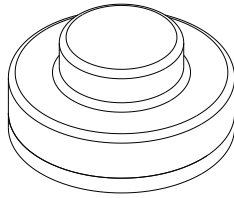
Uiterlijk van automatische sprinklerinstallatie
